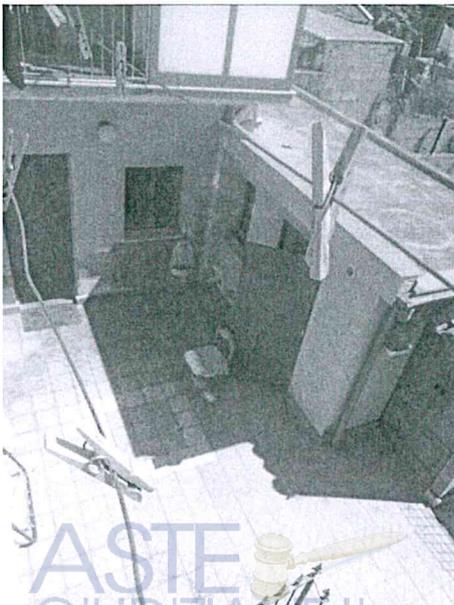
a-b Vista corpo secondario - Bagno p.t
